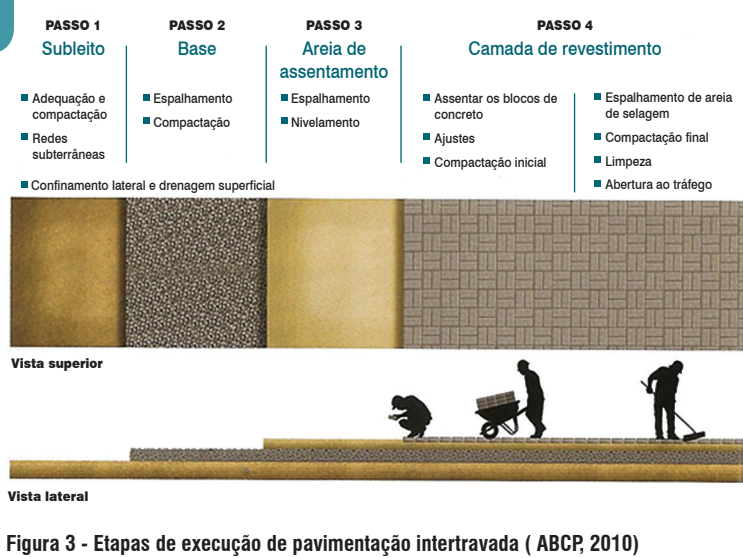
Etapas de execução de pavimentação intertravada (ABCP, 2010)
